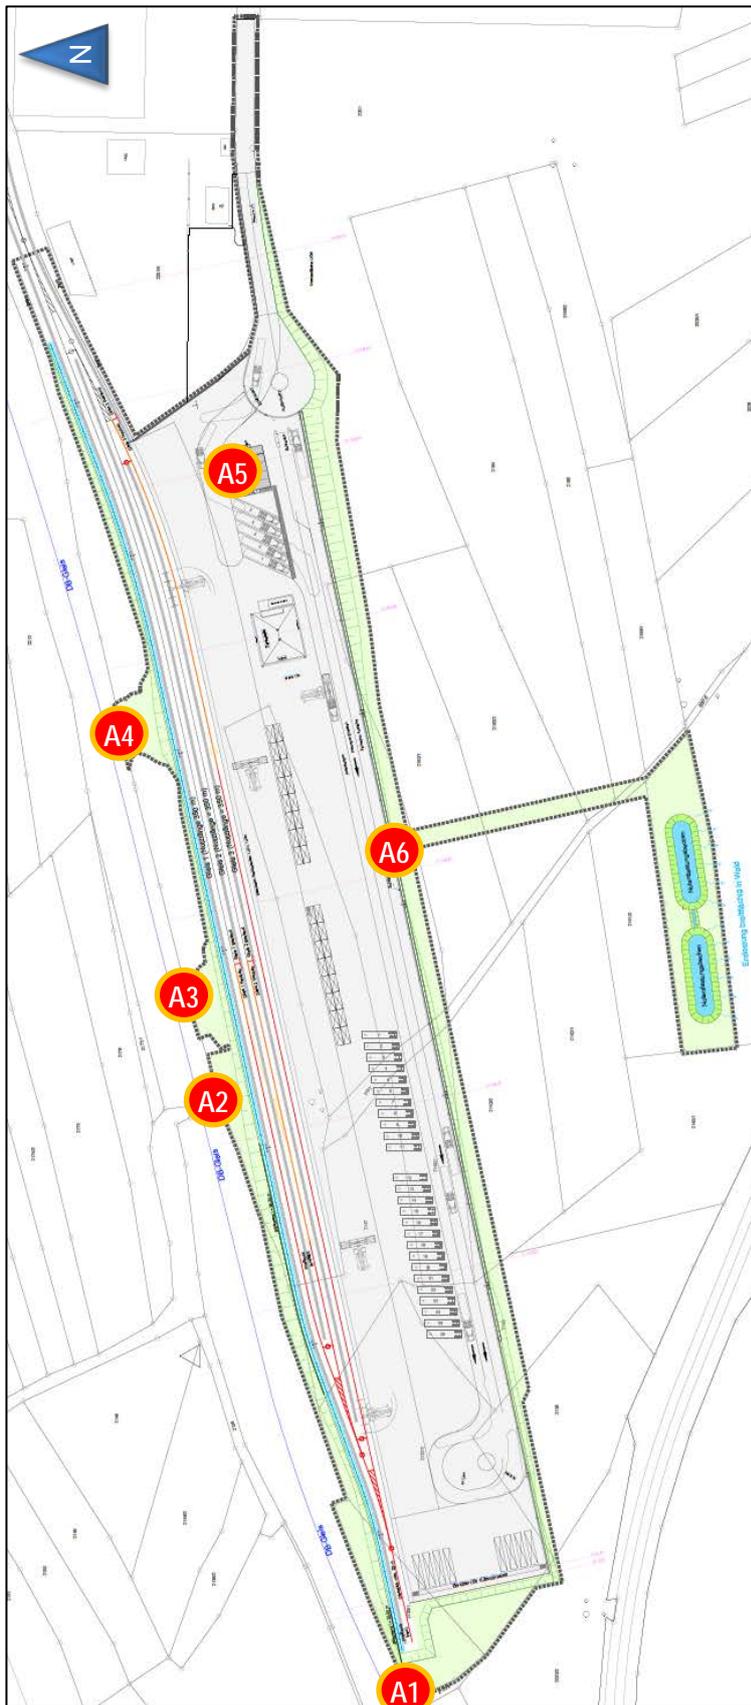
Lageplan des Plangebiets mit Immissionsorten A1 bis A6
